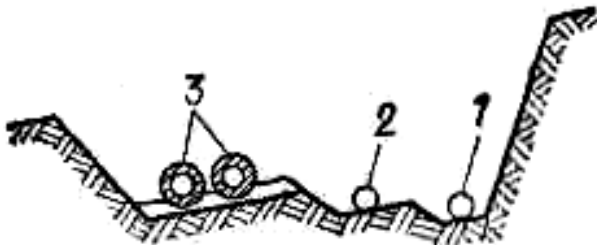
Спільна прокладка газопроводу з іншими комунікаціями: 1 – водопровід; 2 – газопровід; 3 - теплопровід
